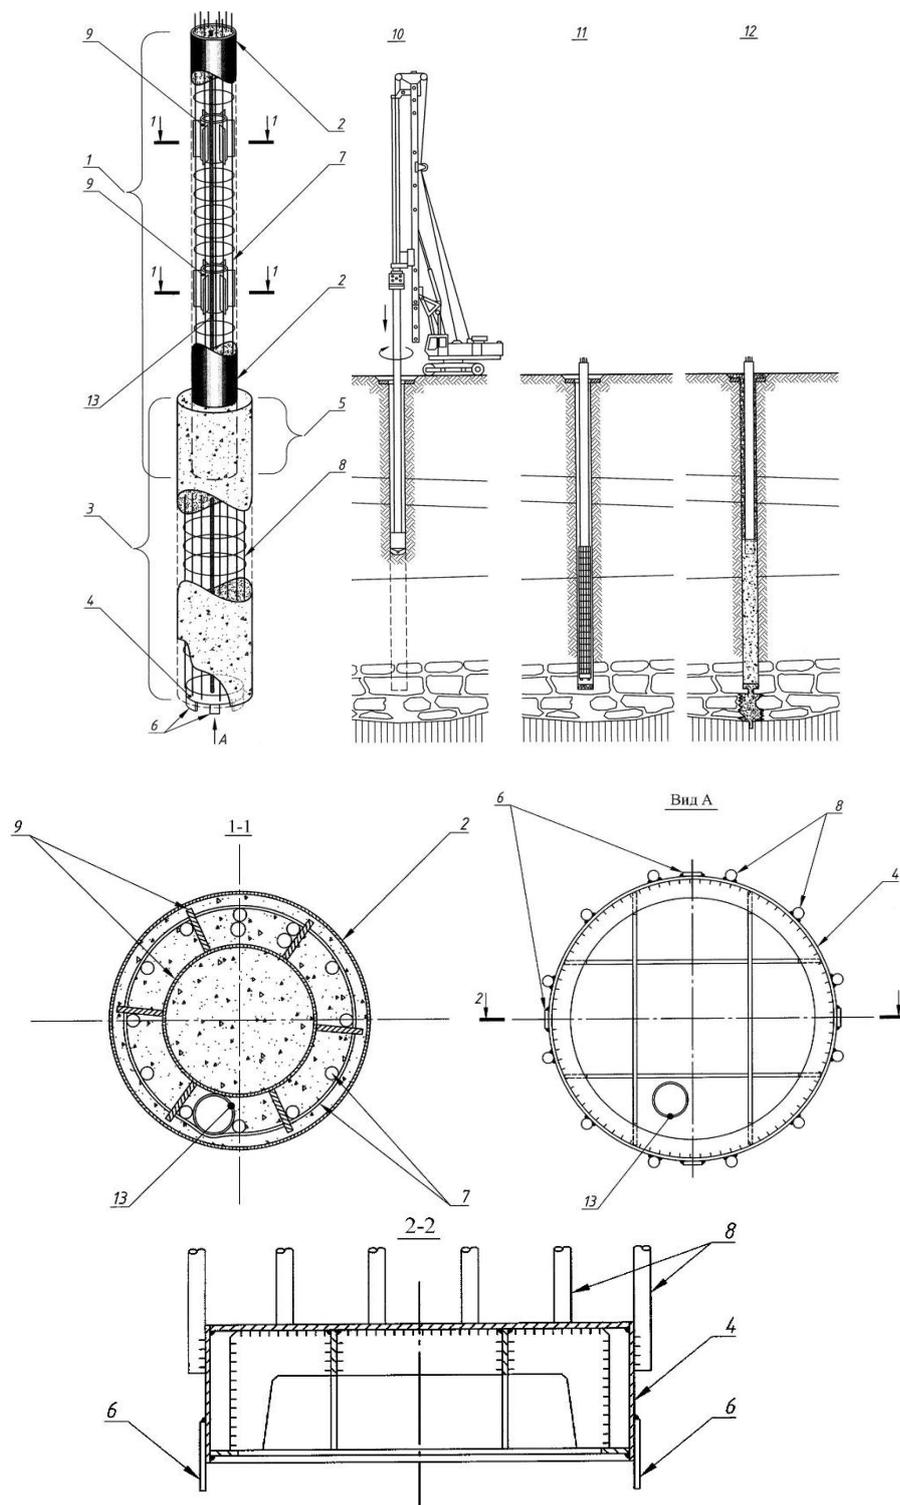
Конструкция железобетонной буровой колонны: 1 – верхняя опорная часть колонны; 2 – неизвлекаемая опалубка; 3 – нижняя фундаментная часть колонны; 4 – призабойная камера; 5 – заделка; 6 – фиксаторы; 7 – арматурный каркас (верхняя часть); 8 – арматурный каркас (нижняя часть); 9 – закладная деталь с радиальными ребрами; 10 – бурение скважины; 11 – погружение и центрирование арматурного каркаса; 12 – замоноличивание колонны; 13 – технологический трубопровод для выполнения уширения и цементации грунтового основания.
